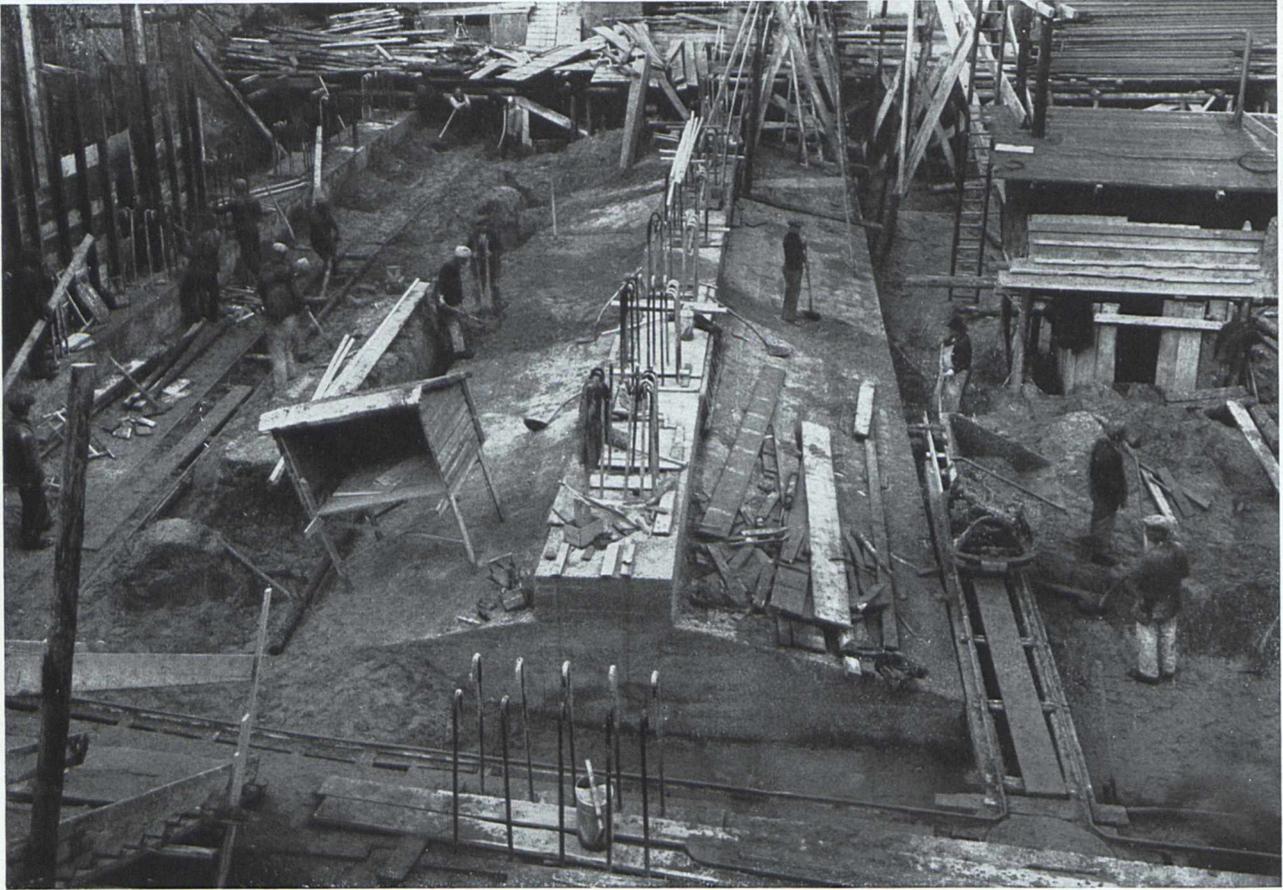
Bauausführung: Adolf Stöhr, Bauunternehmung, München, Schwanthalstraße 11
